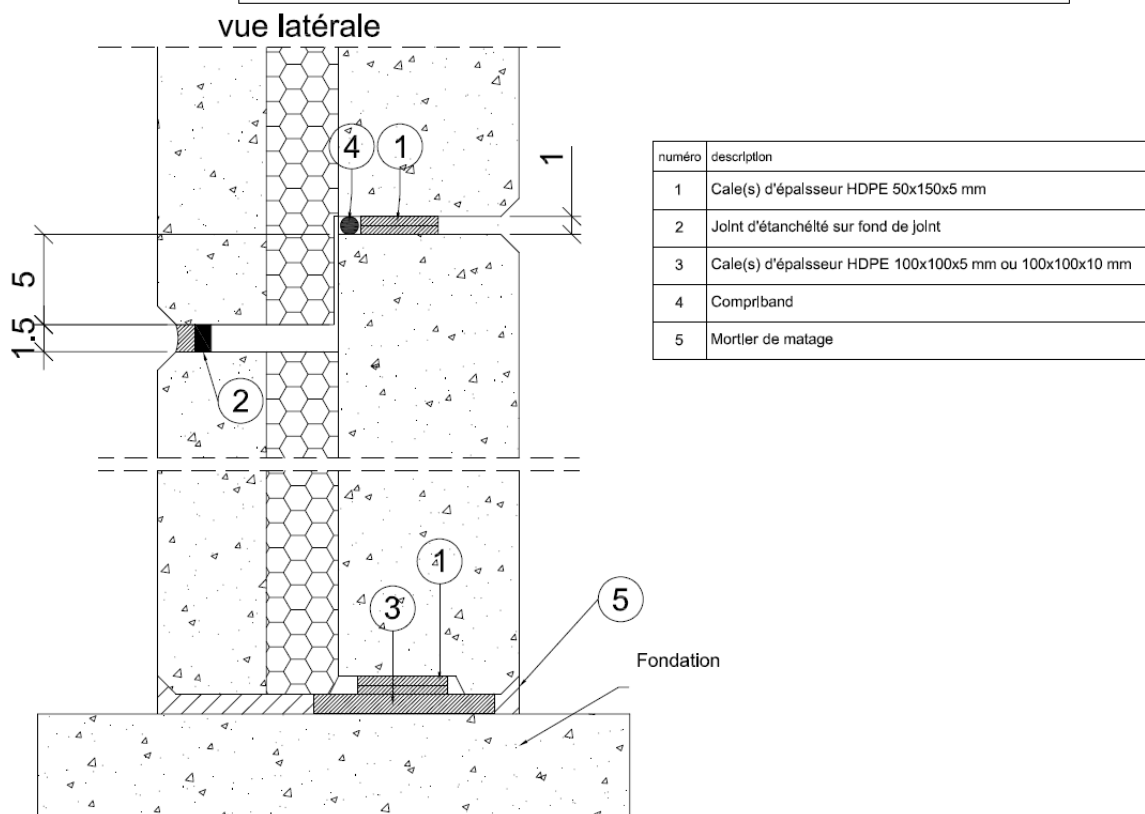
Pose des panneaux dans le cas d'une façade d'un bâtiment de logement (exemple)
